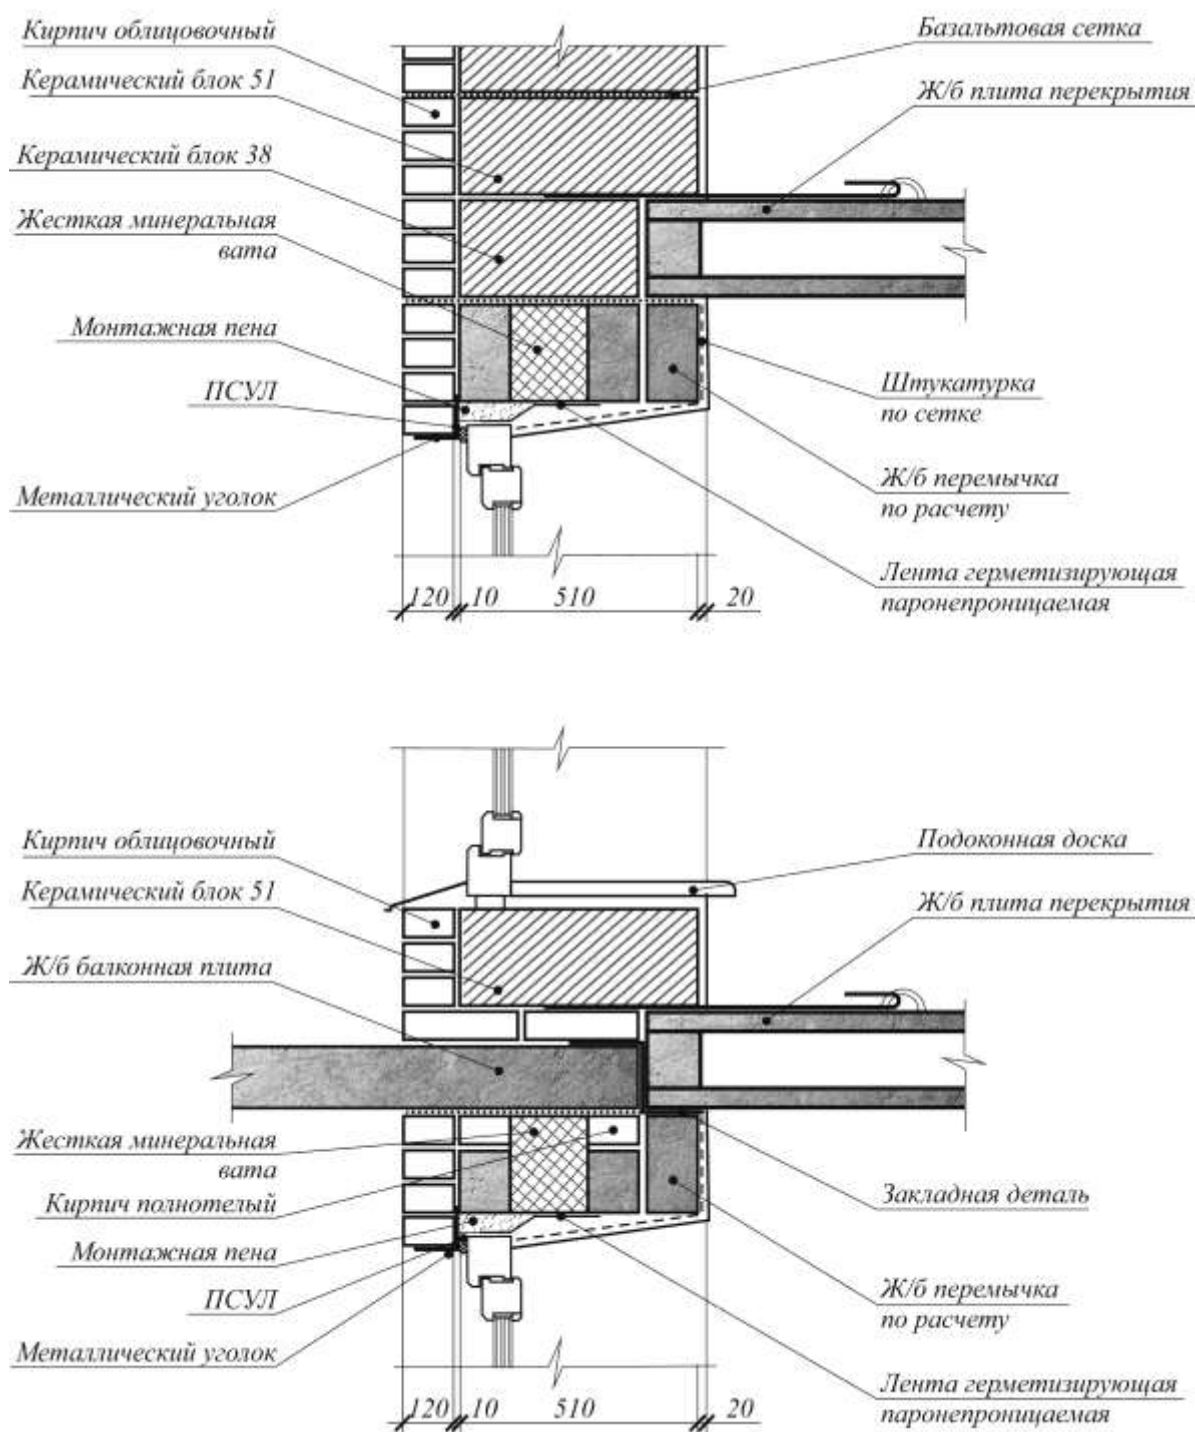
Узлы опирания железобетонной плиты перекрытия на однослойную стену из крупноформатного керамического блока с облицовкой из лицевого керамического кирпича
